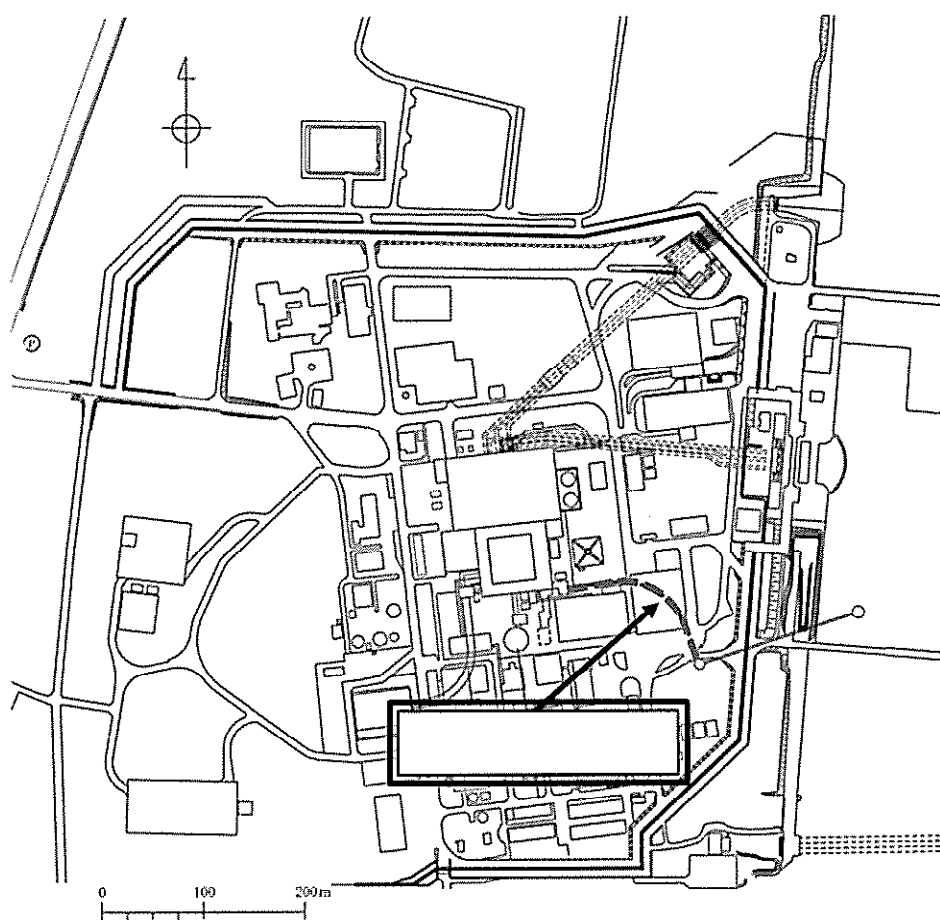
(1) 緊急用海水取水管 平面位置図 (全体図)
